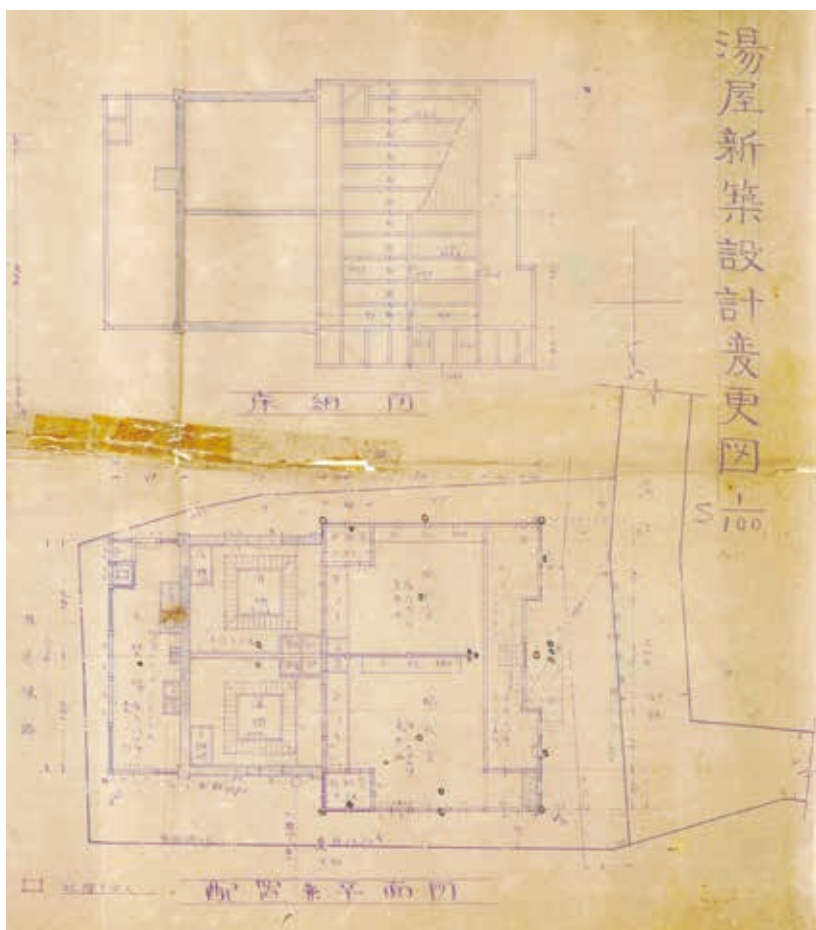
当初湯屋新築設計変更図 床組図 配置図及平面図
